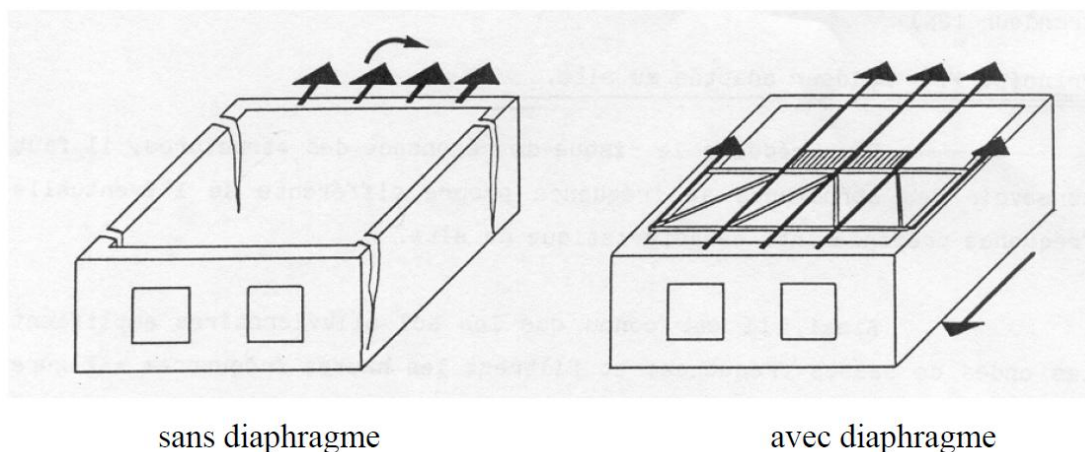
Effet d'un séisme sur une construction en maçonnerie [2]
